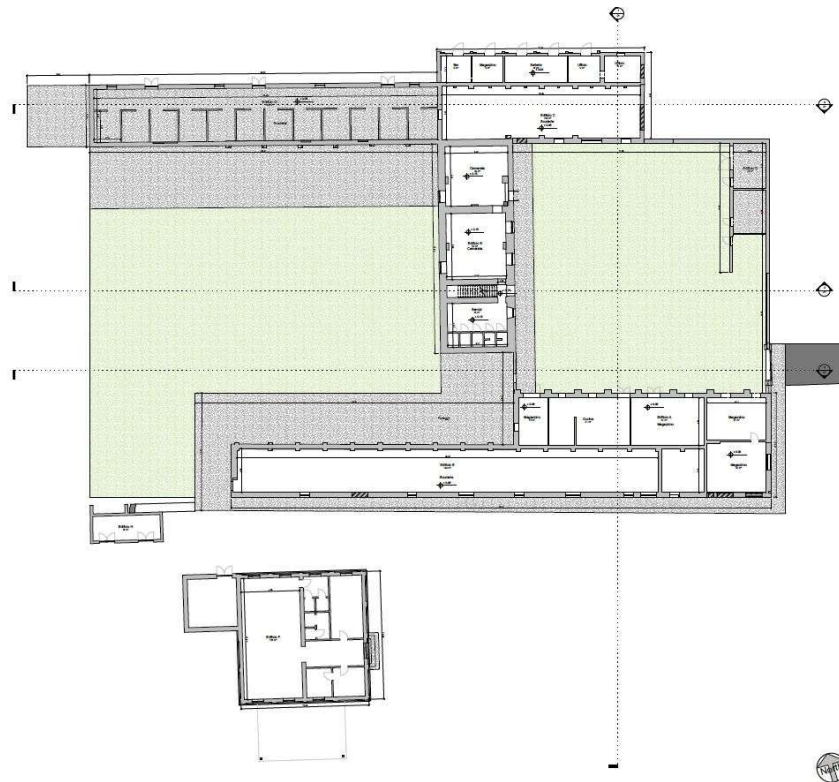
Ex Galoppatoio – planimetria stato di fatto
